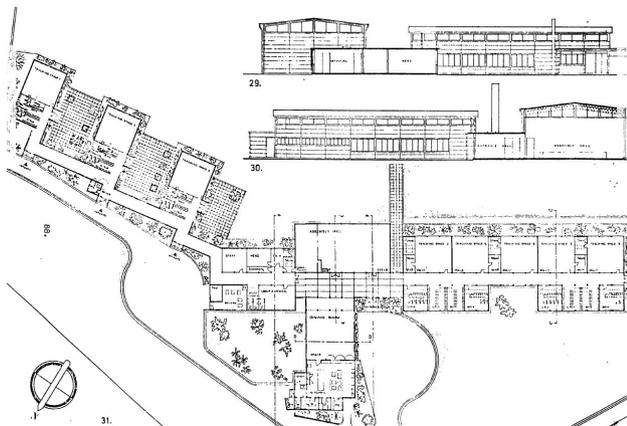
Planta y alzados de *Burleigh Primary School*, Cheshunt. Edificio proyectado en 1946.
